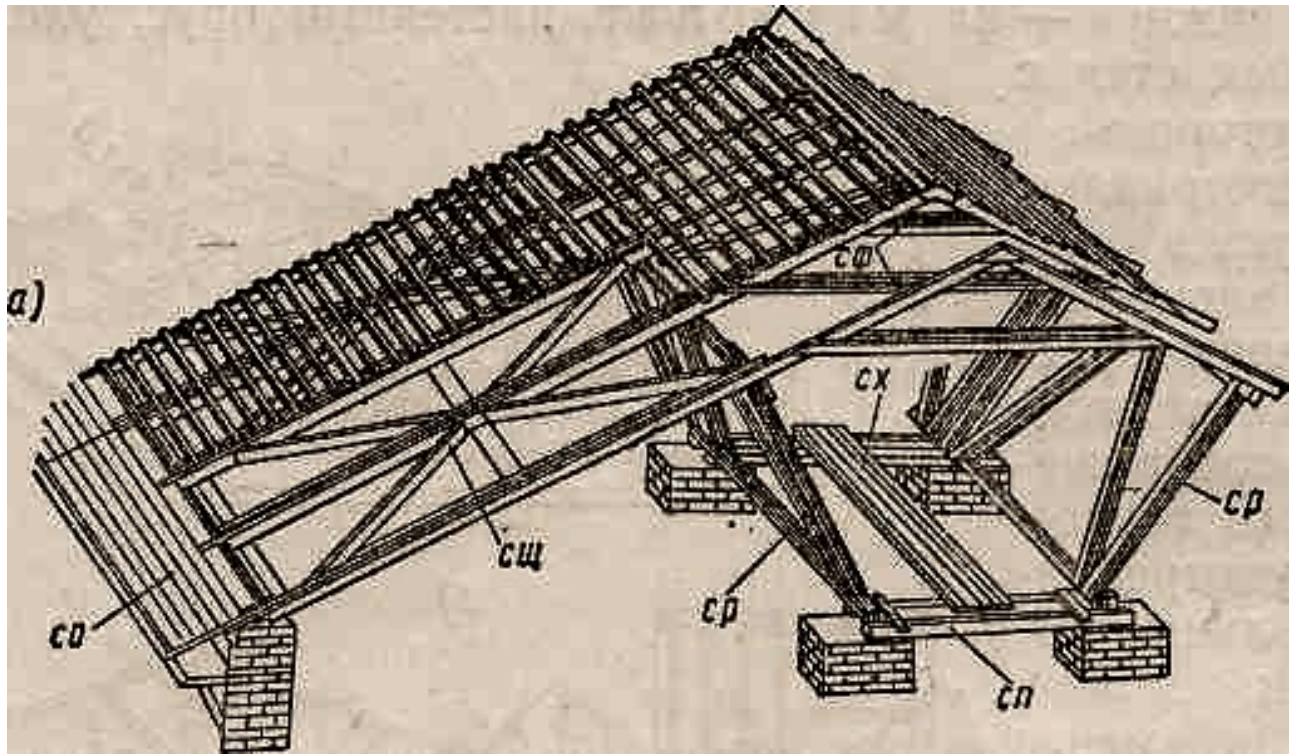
Сборные дощатые наслонные стропила системы САКБ
